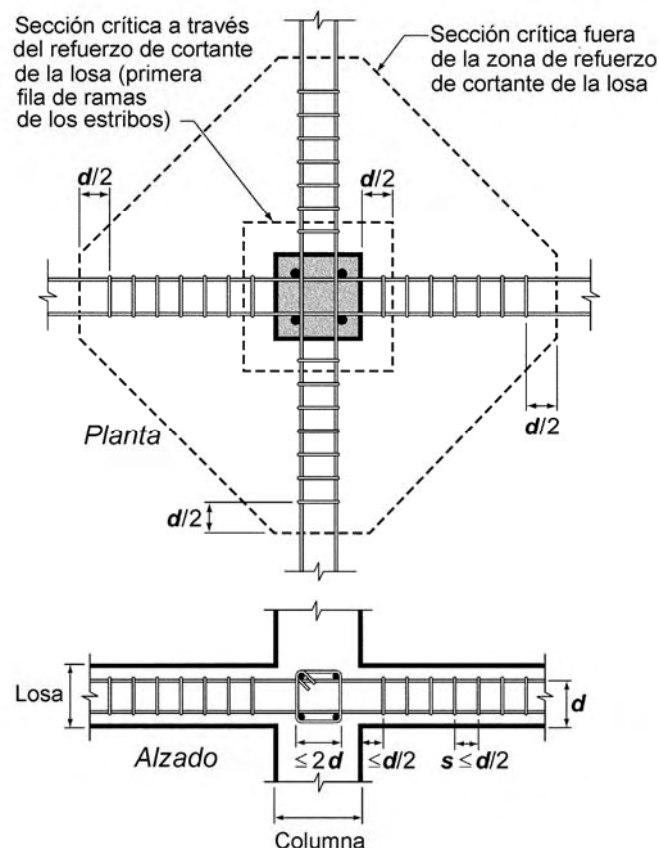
(d) — Disposición de estribos de cortante, columna interior
